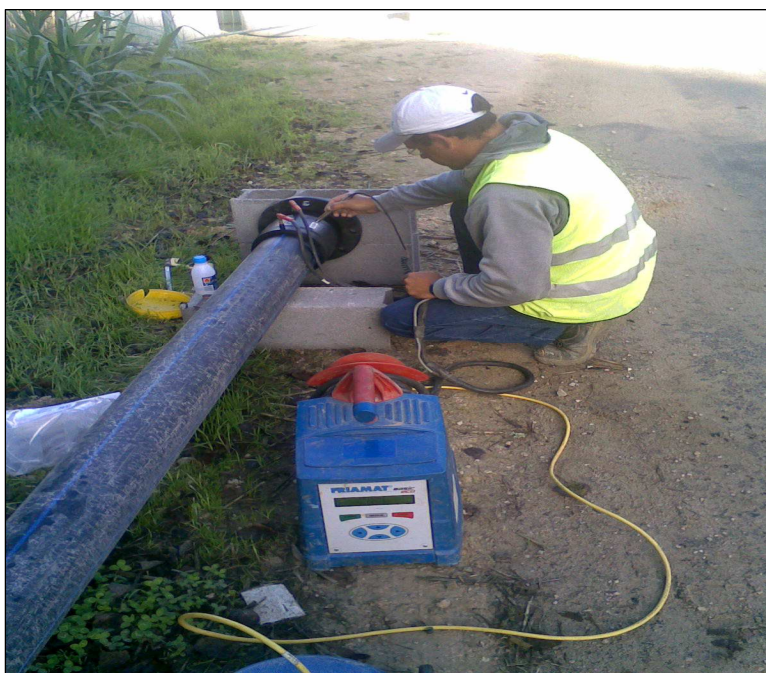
Execução de soldadura por electrofusão de tubo PEAD a um acessório (Stub-end com flange)
